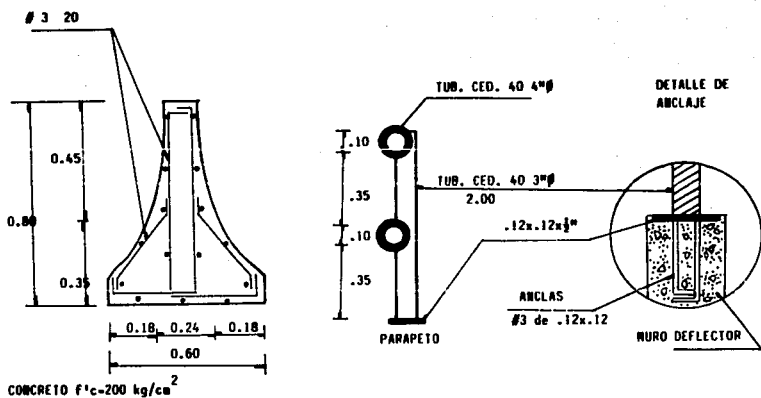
MURO DEFLECTOR Y PARAPETO
